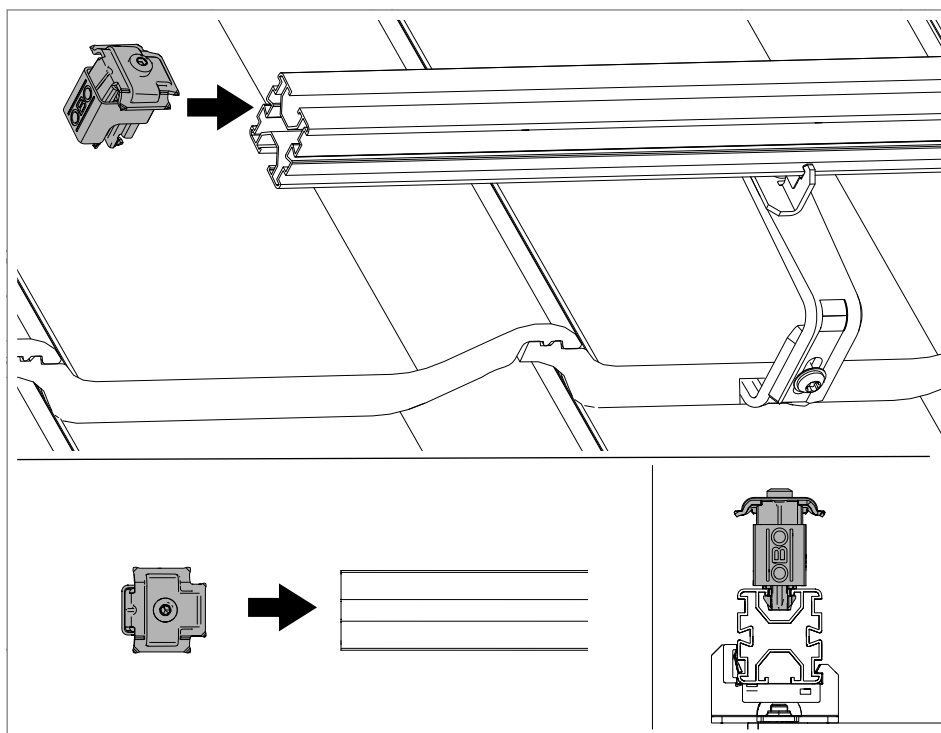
Montar o perfil de estrutura em ganchos de telhado para grandes cargas
